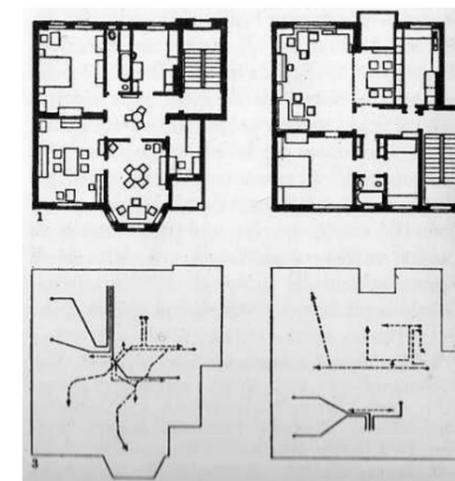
Zonificación de planos de vivienda, Alexander Klein, 1928.
